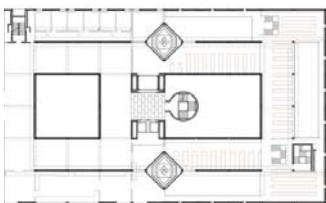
Centro de Artes e Estudos Britânicos da Universidade Yale, Louis Kahn, New Haven, 1969-77. Planta Baixa.
